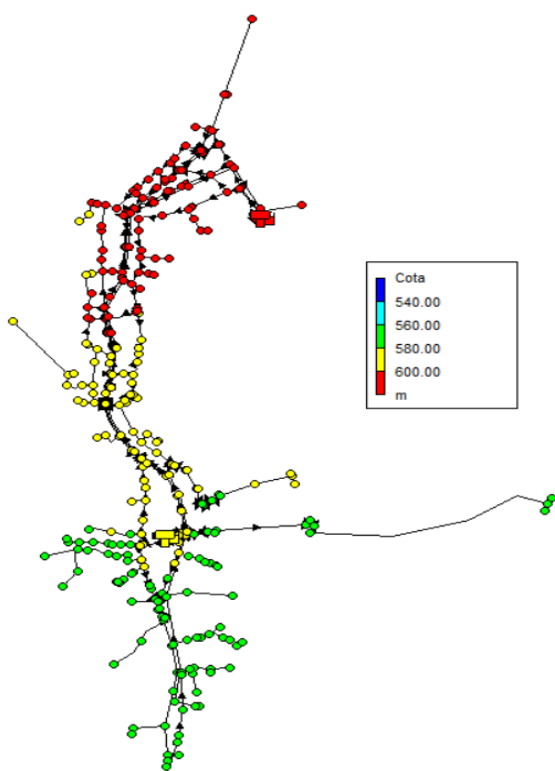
Planimetria da rede de distribuição. Fonte: Autor (2022)
